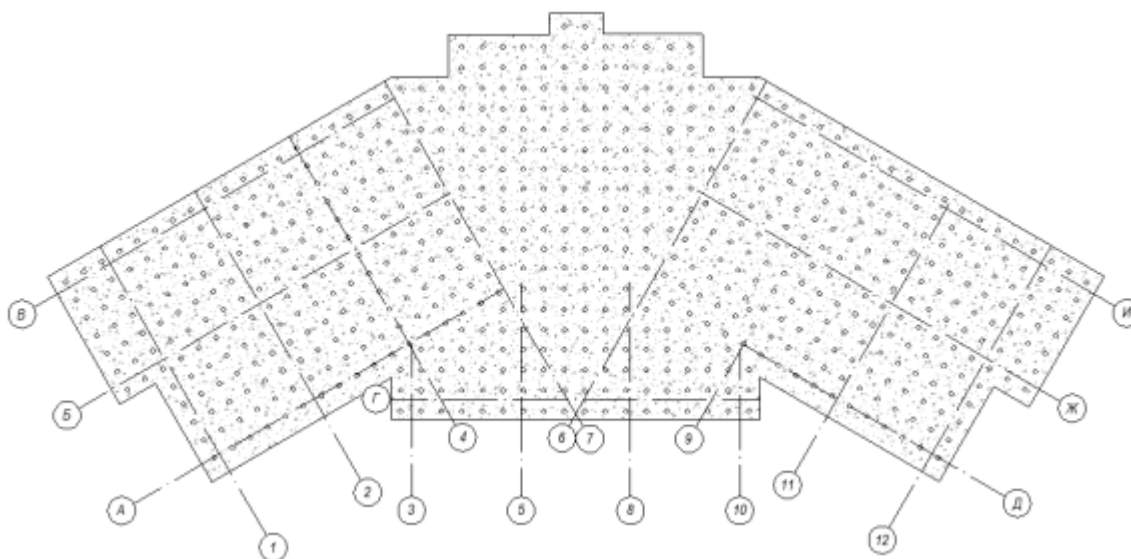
Опалубне креслення монолітної плити фундаменту з буронабивними палями
